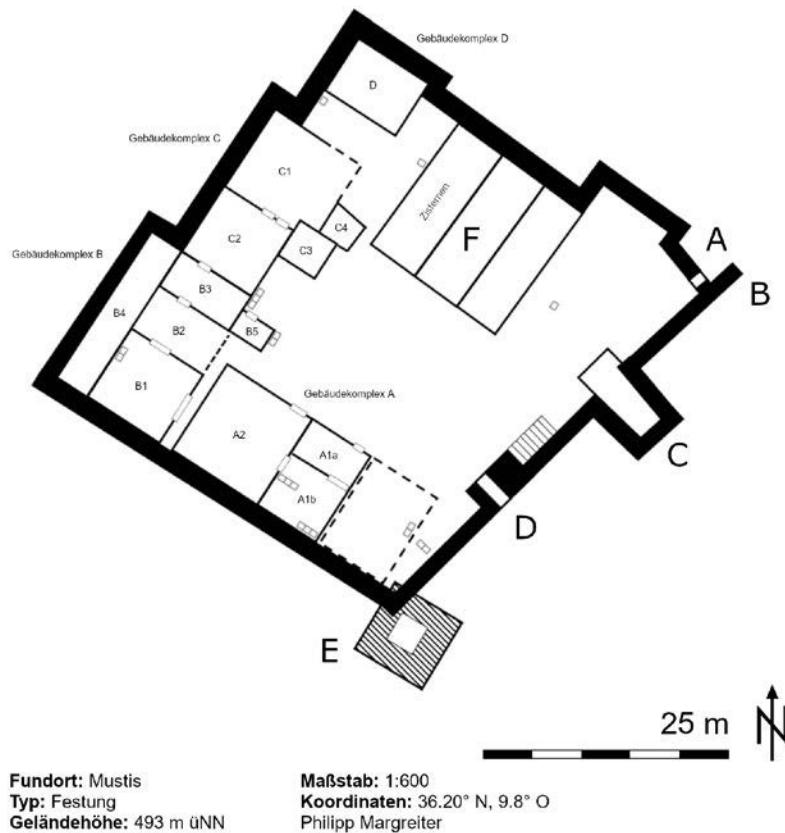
Mustis. Grundriss der Festung (in grau Trogelemente)
